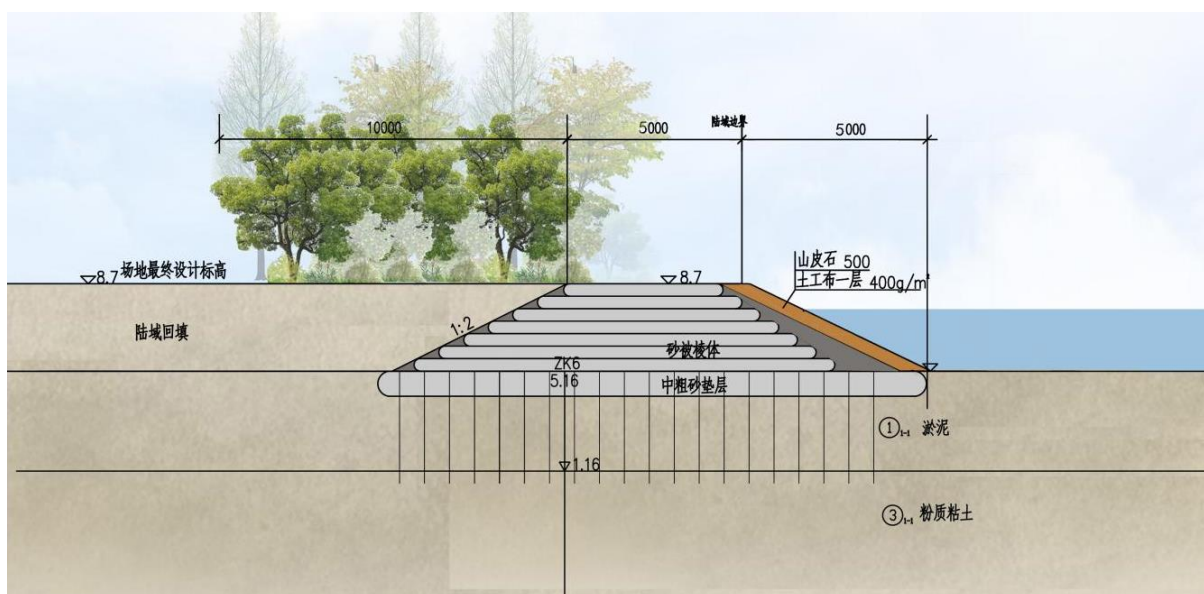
生态防风林种植断面示意图（长 1683m）
